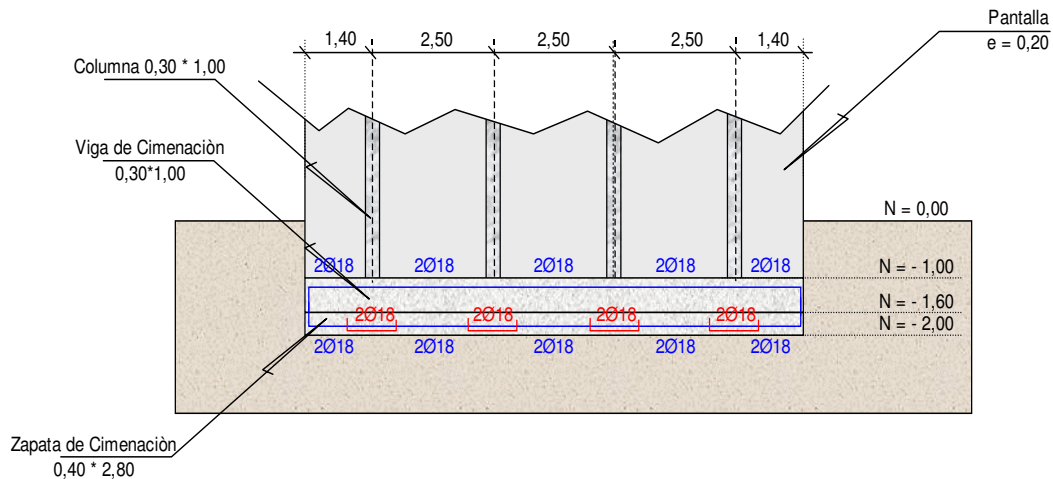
Geometría y distribución de acero en la viga de cimentación
